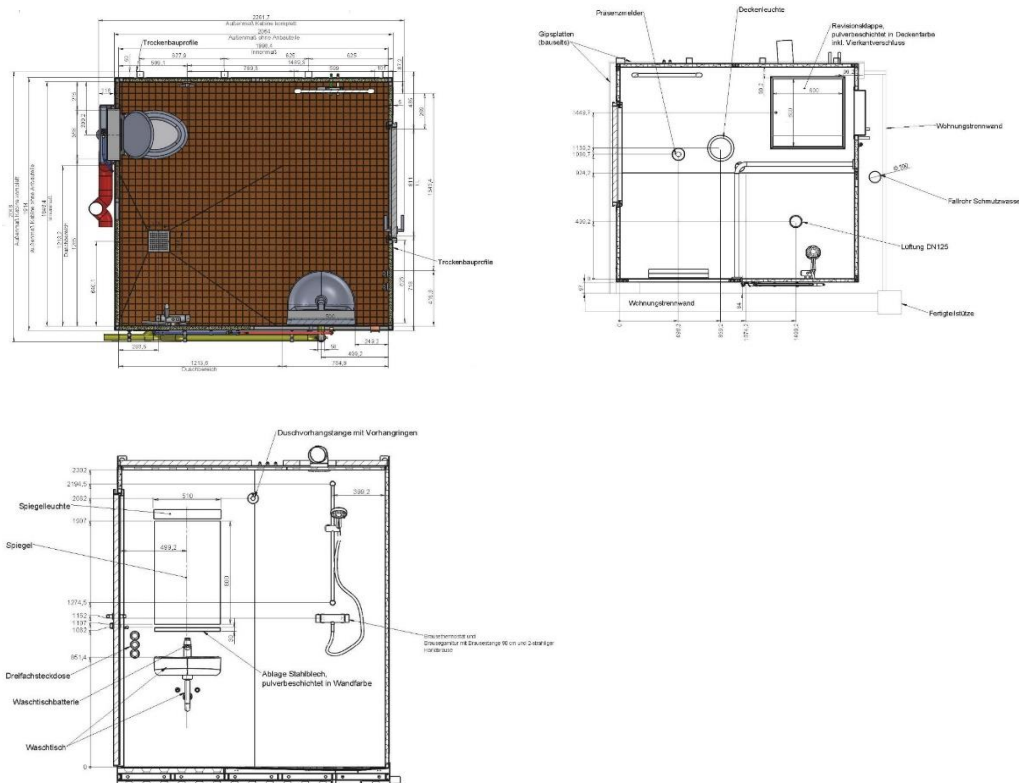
Montageplanung der Fertignasszellen - Bochum - Schnitt und Grundriss, [Stengel GmbH]
